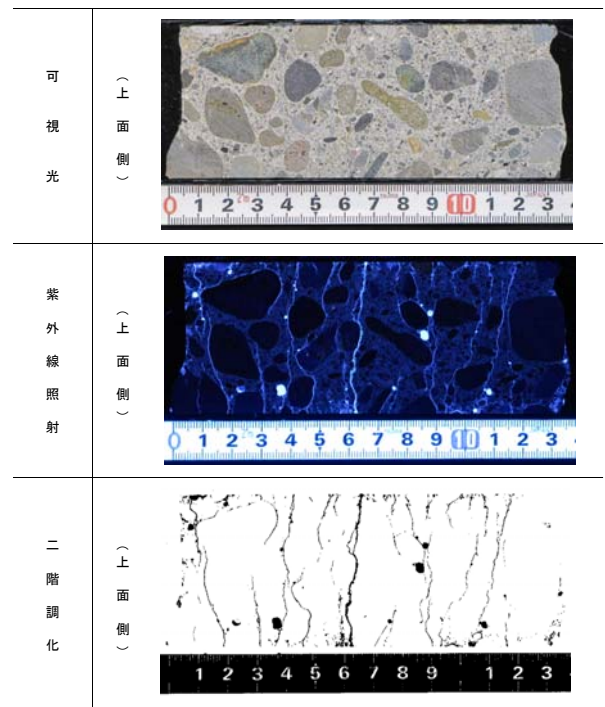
微細ひび割れ観察 (第2径間コア)
